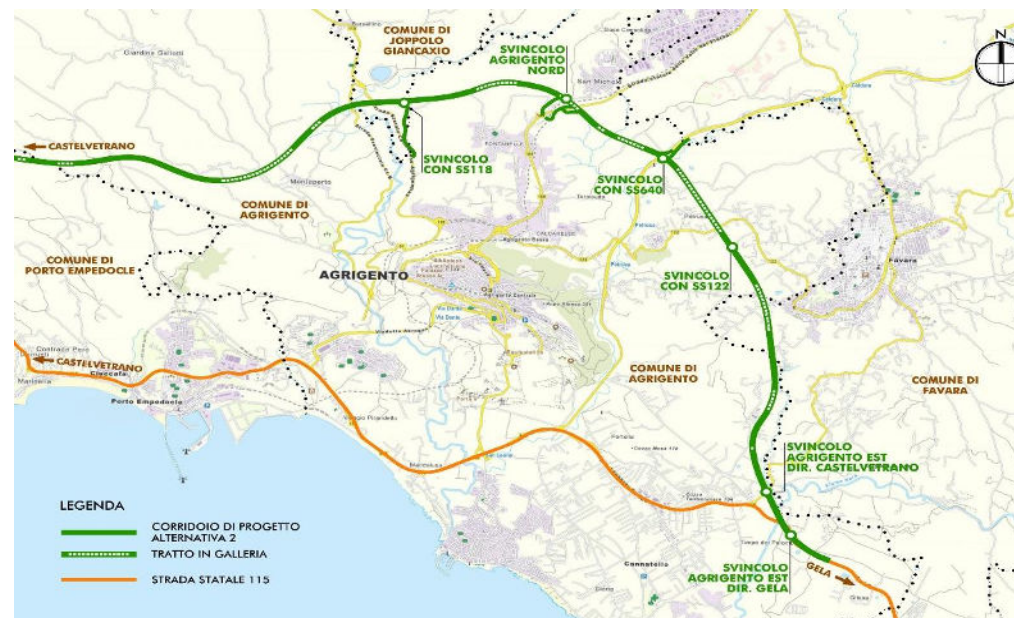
Alternativa 2: planimetria di progetto tratto est
